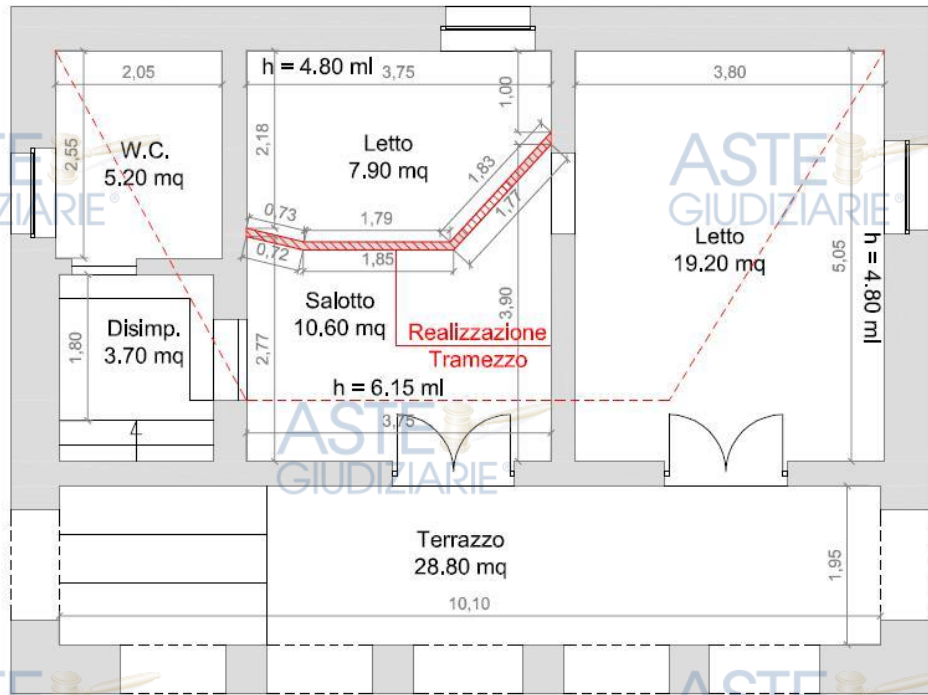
Planimetria Stato di Fatto Abitazione Piano Primo.
